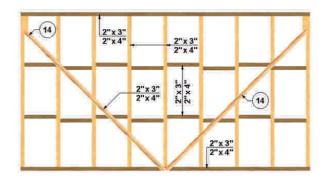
20: Muro arriostrado por medio de diagonales estructurales, de igual escuadría que las piezas principales, pieza N° 14.
